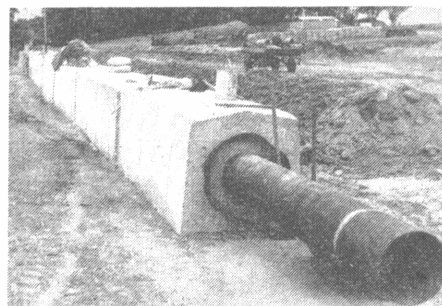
Grundablaß NW400 aus Stahlrohr mit Betonummantelung und Bewegungsfugen aus PVC-Fugenband.
